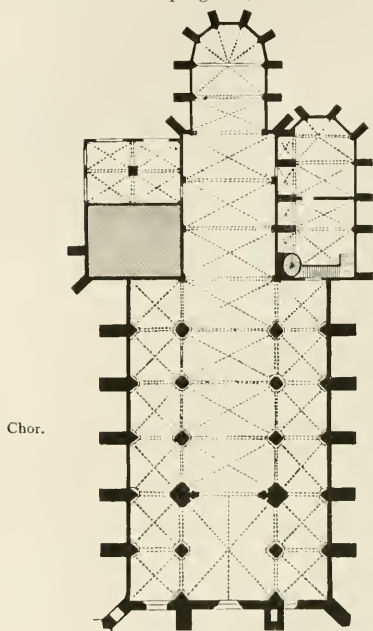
Grundriß der Kirche zu Niederhaslach.
